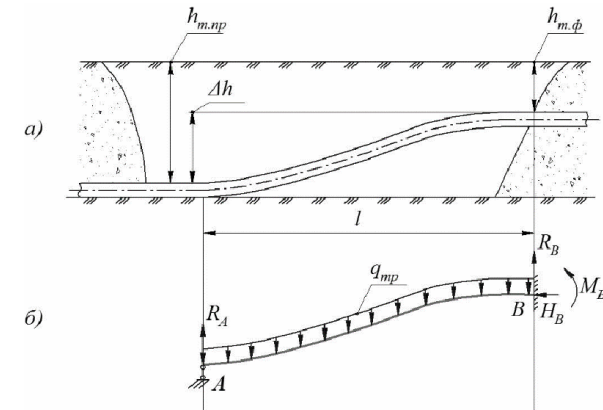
Розрахункова схема укладання трубопроводу на проектну відмітку:
